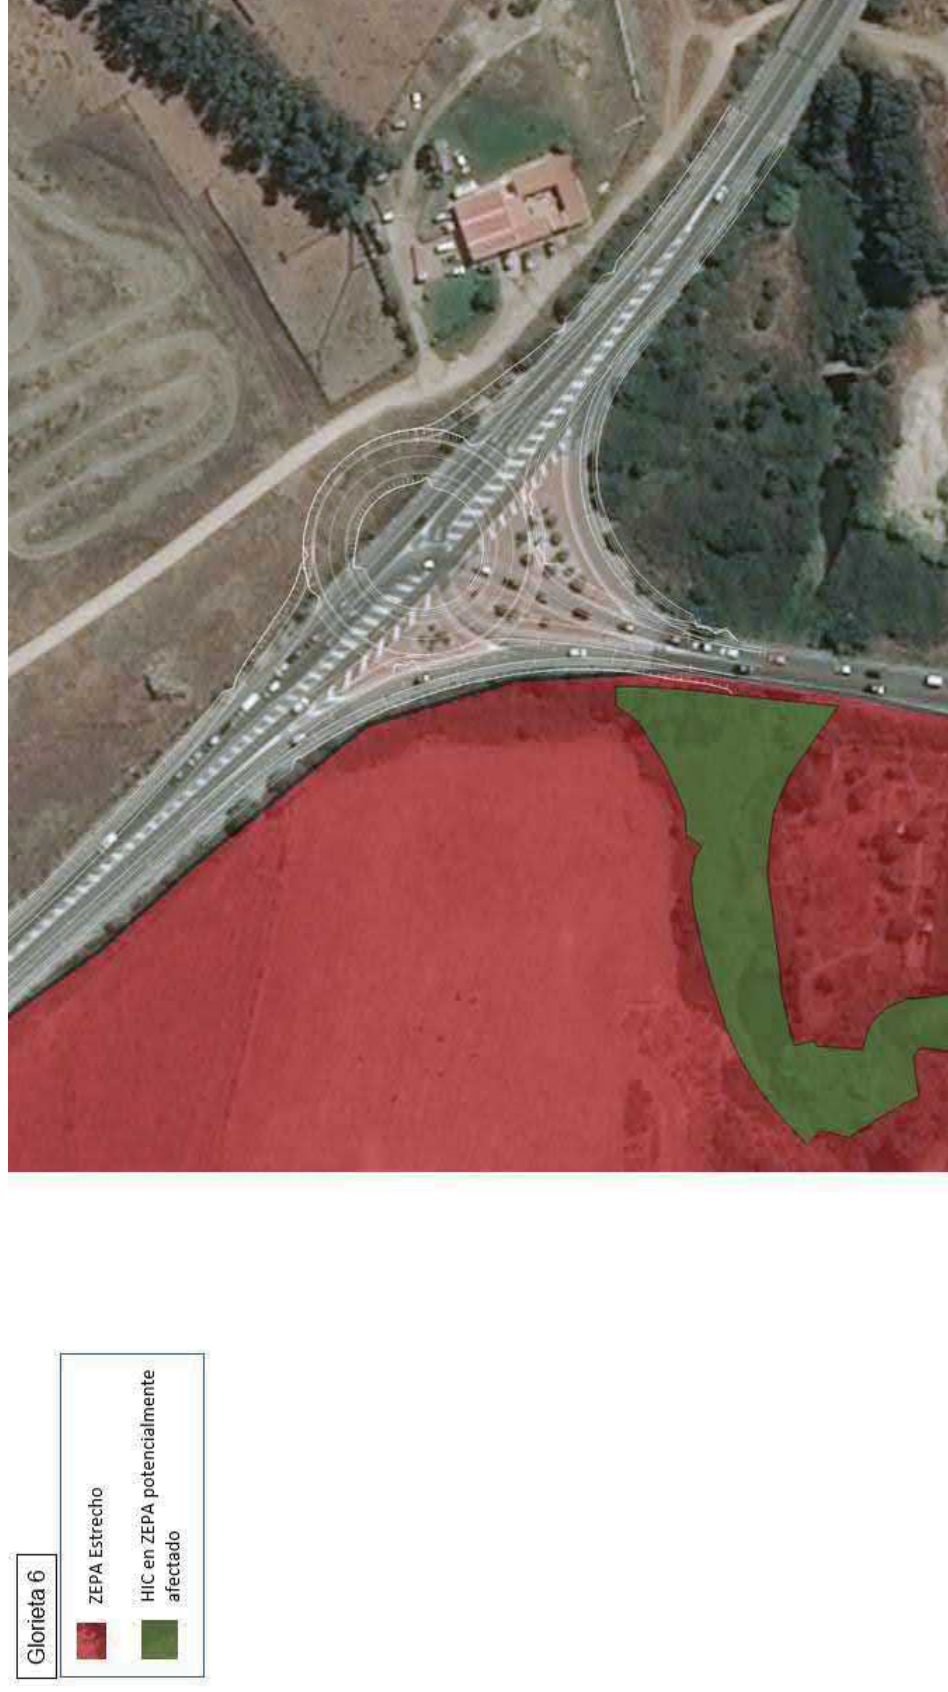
Glorieta 6. Espacio ZEPA Estrecho y planta de proyecto Sin afectación a ZEPA Estrecho
